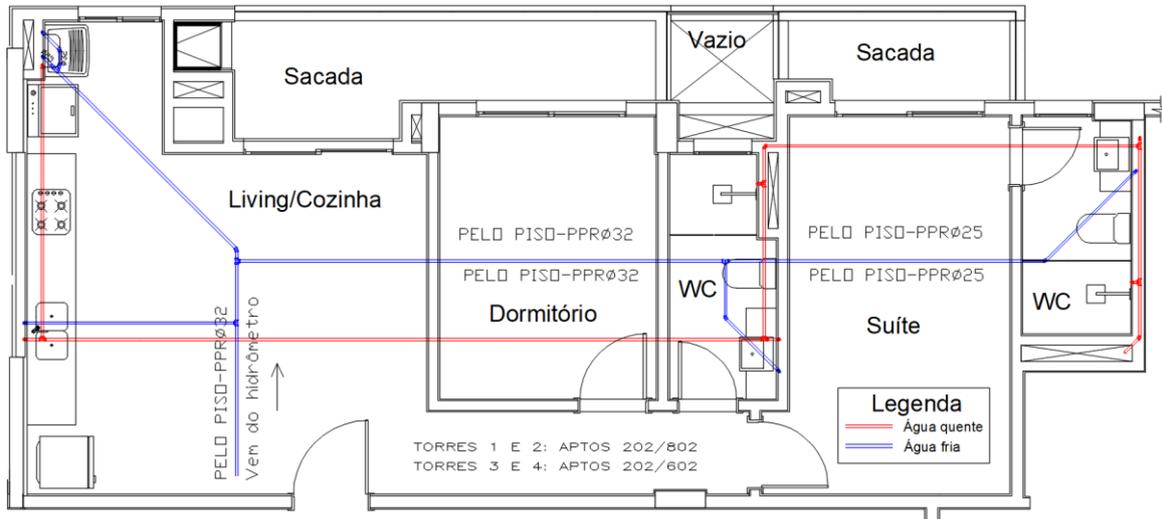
Planta baixa da instalação hidráulica modificada para a planta baixa da Figura 4.
